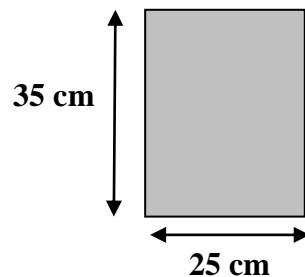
Dimension des Poutre principale, secondaire, Poutre Palière et Poutre de chaînage
